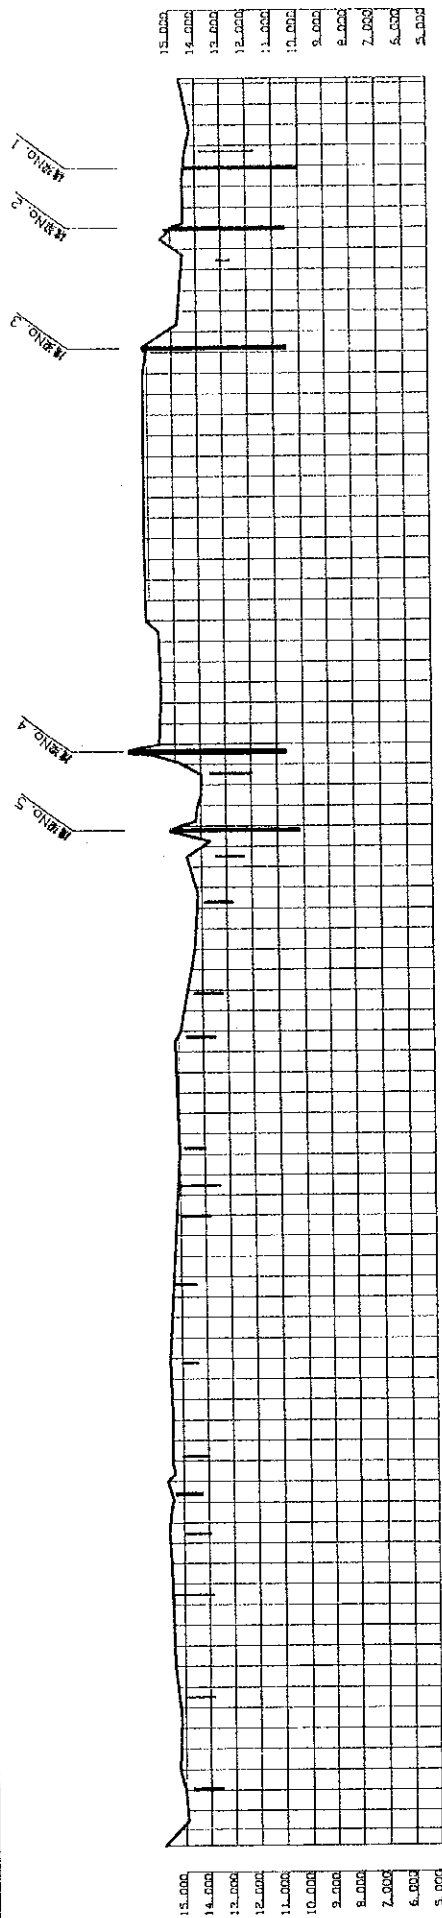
流域断面图 (流域-1, 断面1-3 / 断面1-4, 现状)
